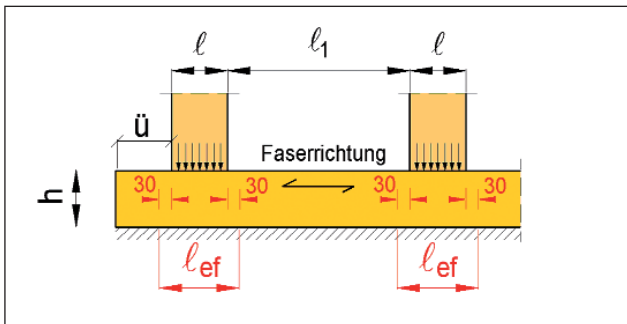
Auflagerdruck (DIN 1052:2008-12 Bild 19)
